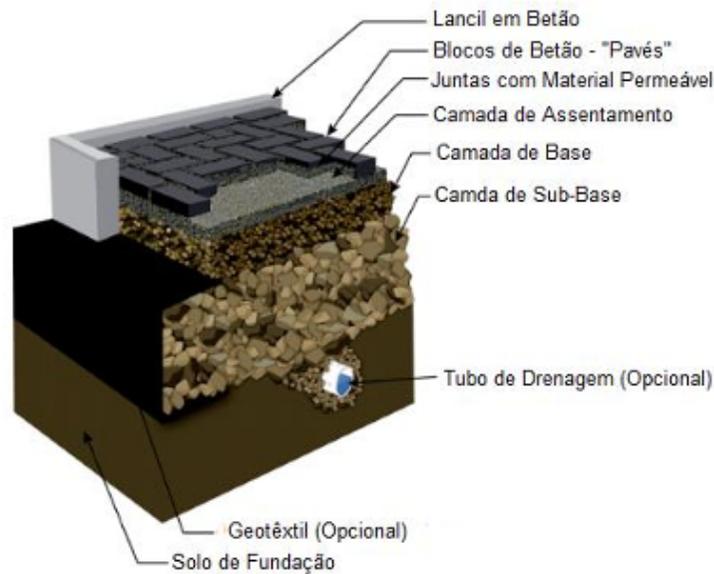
Secção transversal típica de pavimento permeável (STORMWATER CENTER, s.d.)
